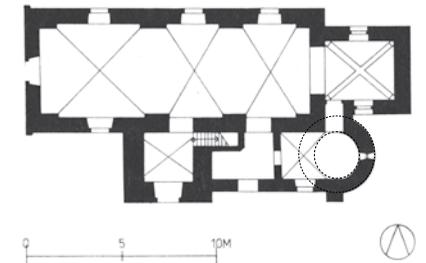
Grundriss Dehio NÖ 1990, 306. M 1:400.
